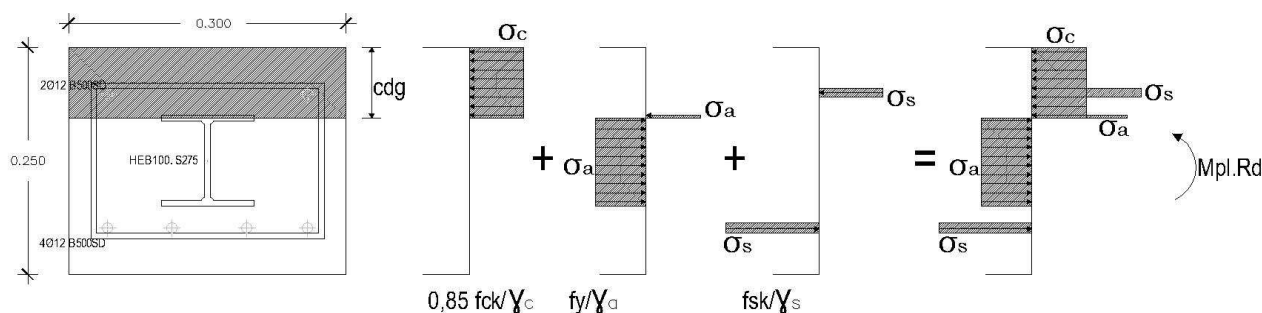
Estados tensionales en el hormigón y acero bajo carga creciente.
